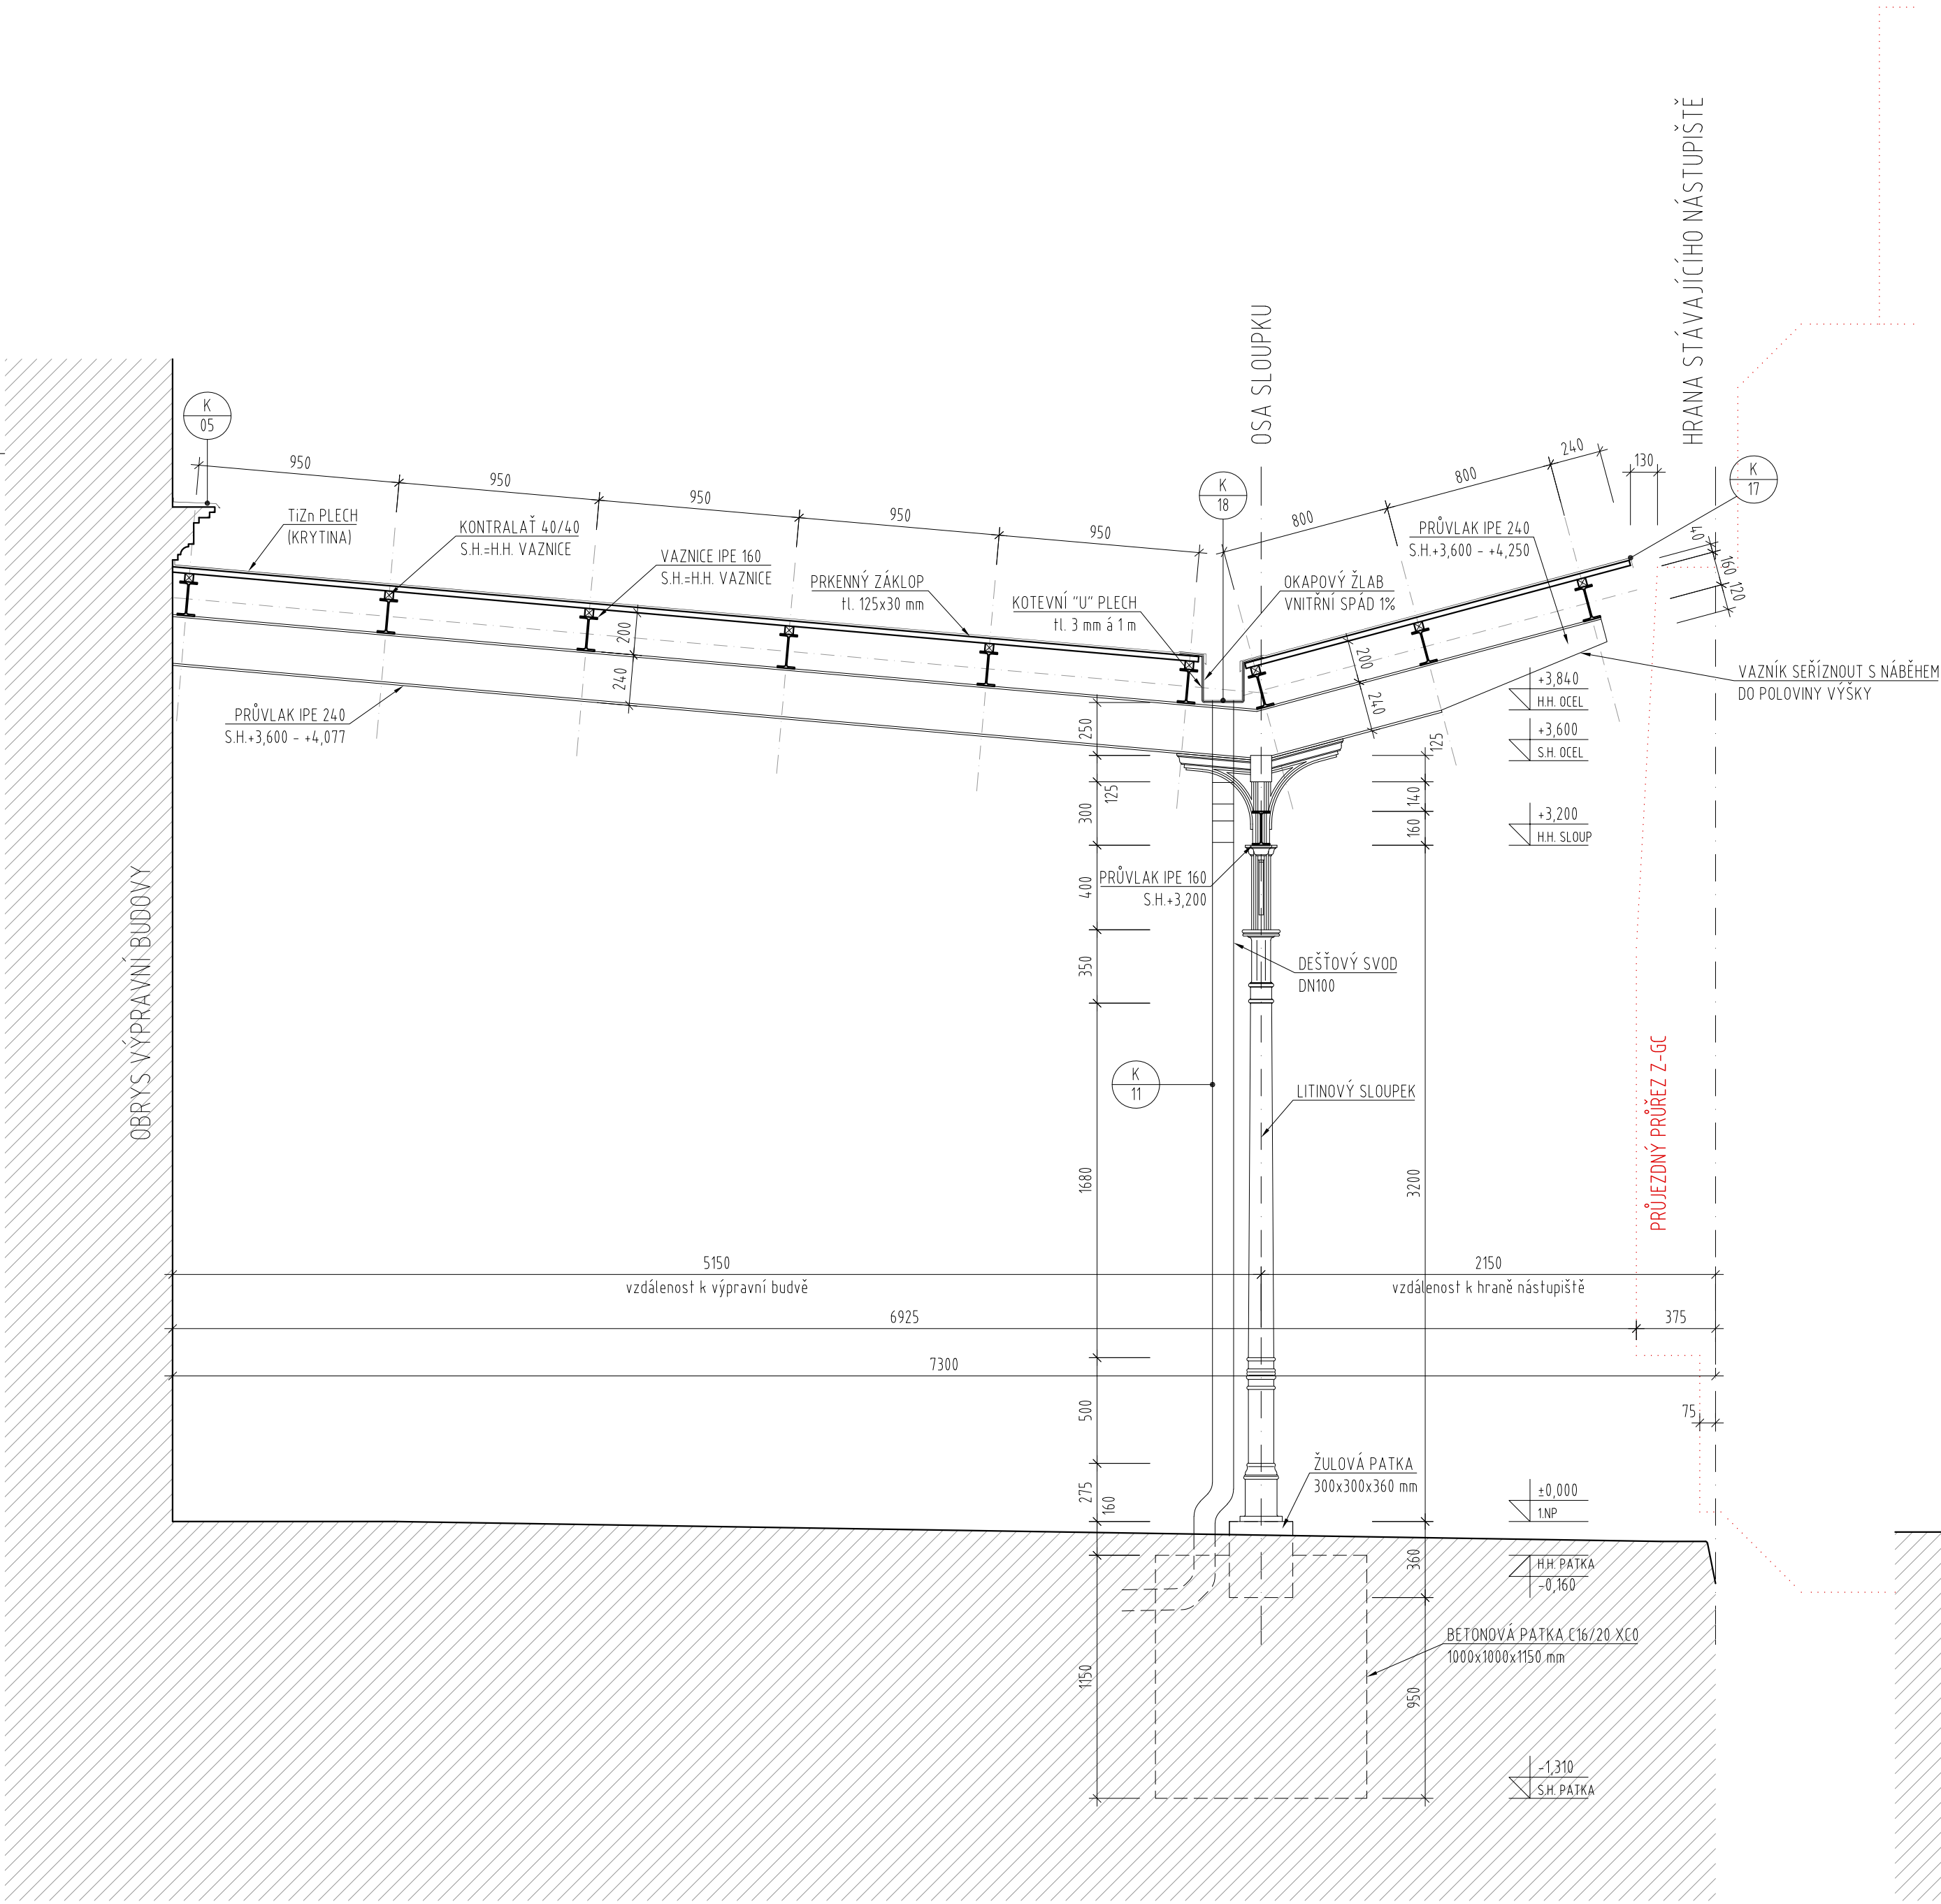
DETAIL NAVRHOVANÉHO ZASTŘEŠENÍ
